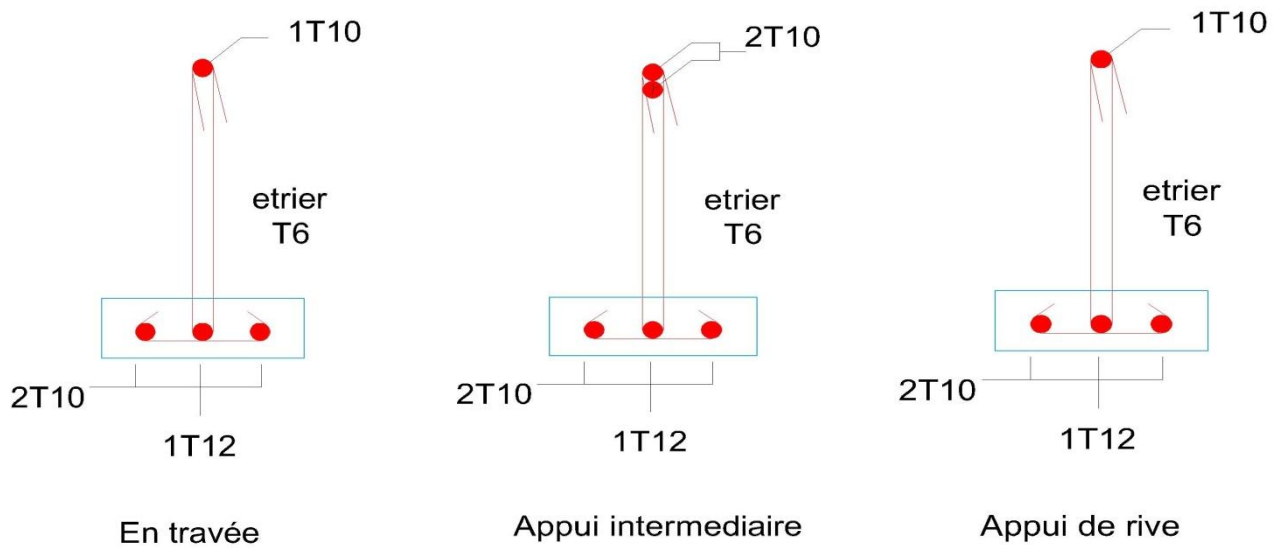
Schéma de ferrailage des poutrelles type 1 de la terrasse inaccessible, terrasse accessible et de l'étage habitation
